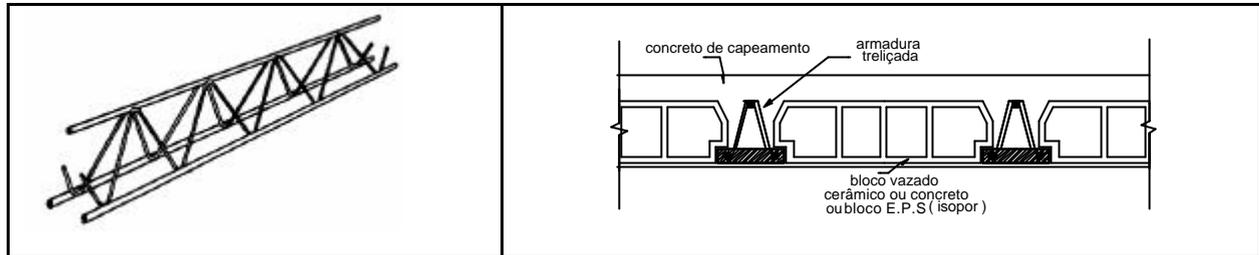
Perspectiva esquemática da armadura treliçada usada em lajes pré-fabricadas e seção transversal após o preenchimento de concreto da laje pré-fabricada com nervura do tipo treliça.
